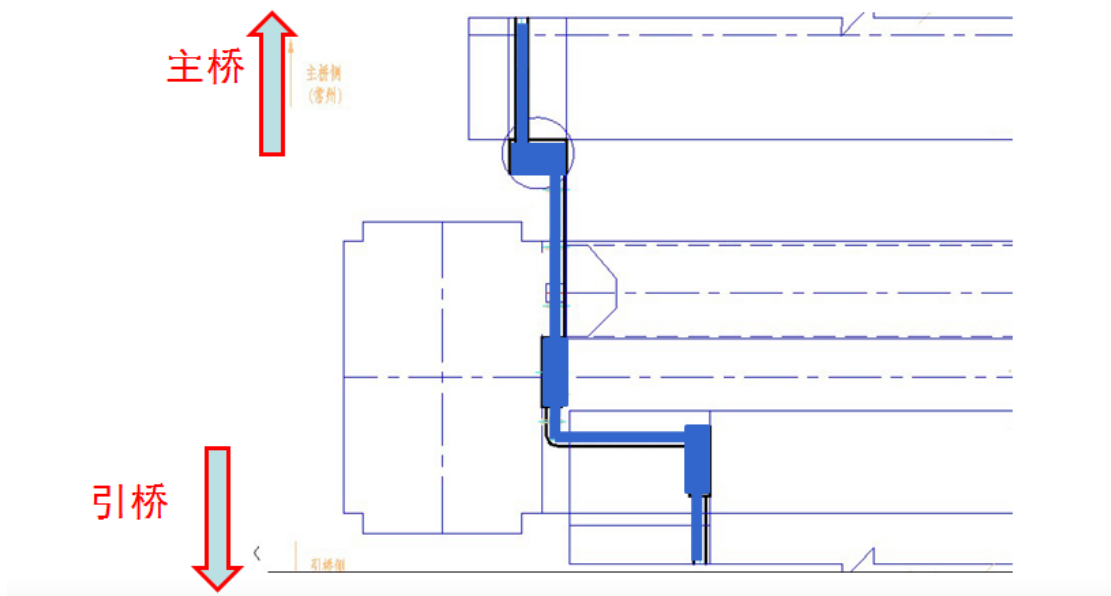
主桥钢箱梁和引桥排水管衔接段平面示意图
